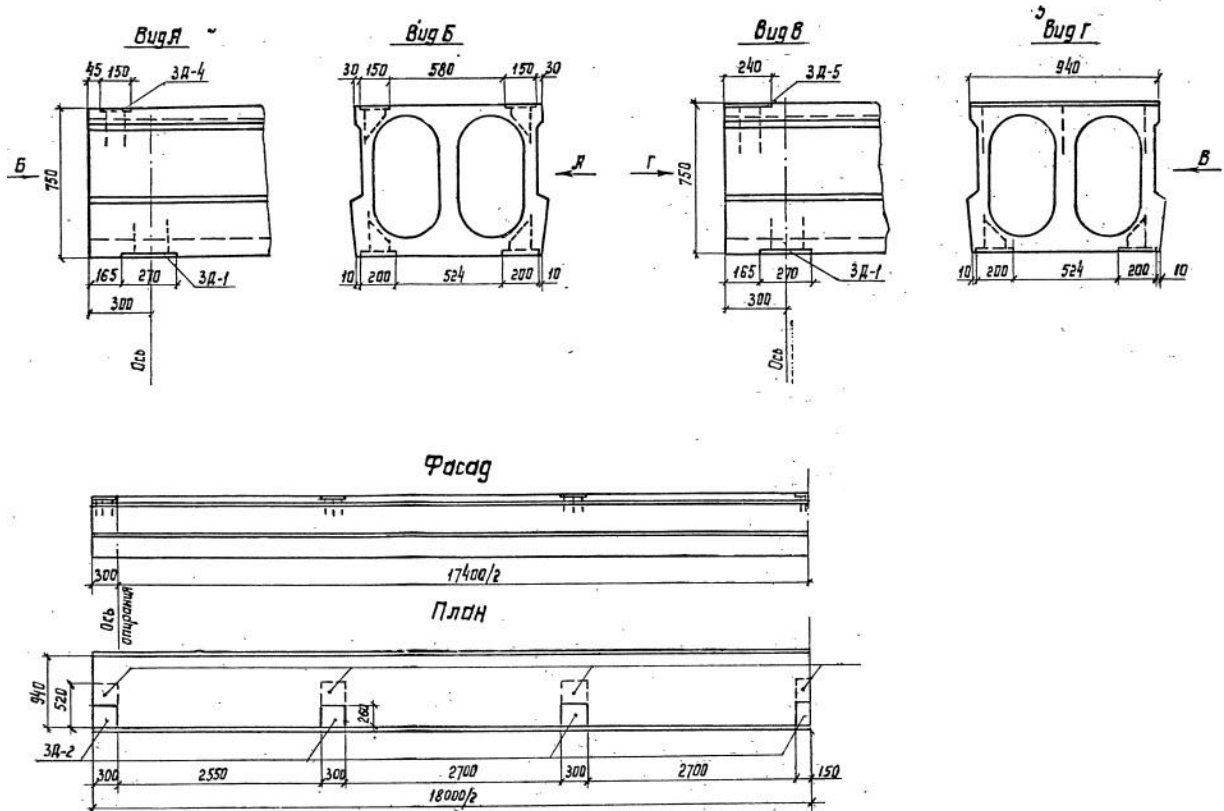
Плита мостового перекриття П 18-10 в проекціях [4]
